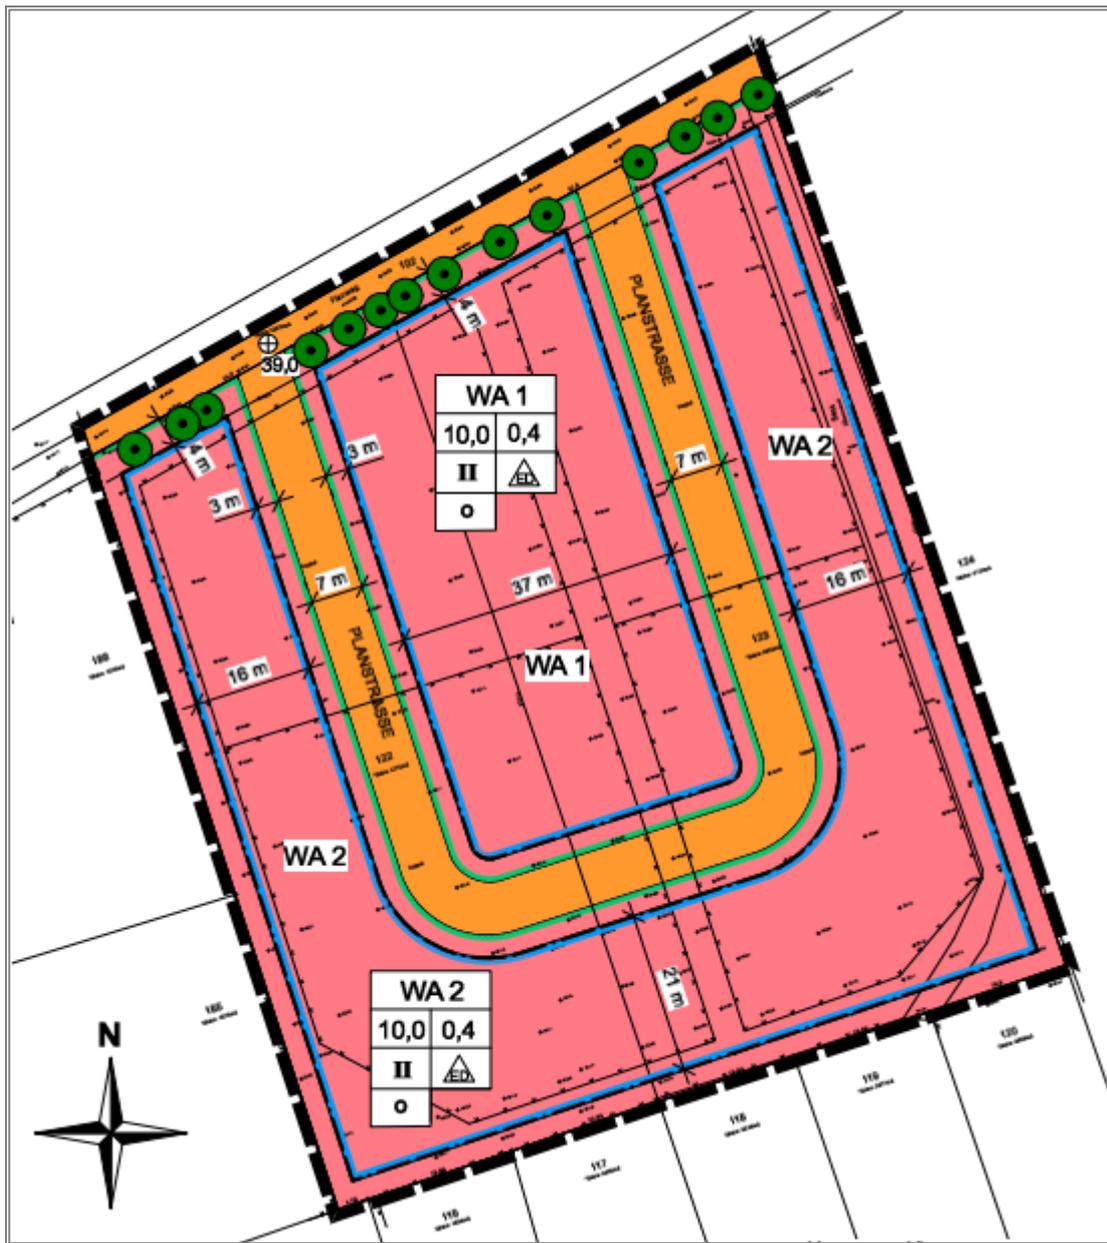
Planzeichnung des B-Plans "Südlicher Planweg"
